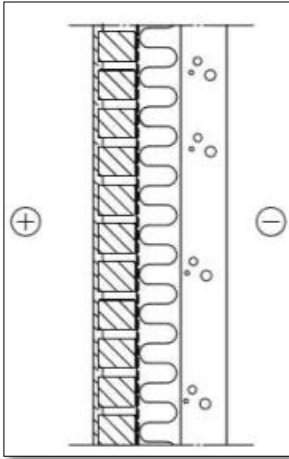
Rakenneavauksesta 18 todettiin sokkelirakenteessa olevan sisäkuori, jonka materiaalia tai paksuutta ei Kiwa Inspectan raportissa ilmoitettu. Eristekerroksena todettiin 50 mm:n paksuinen korkkieriste ja ulkokuorena 160 mm:n paksuinen betonikerros.
